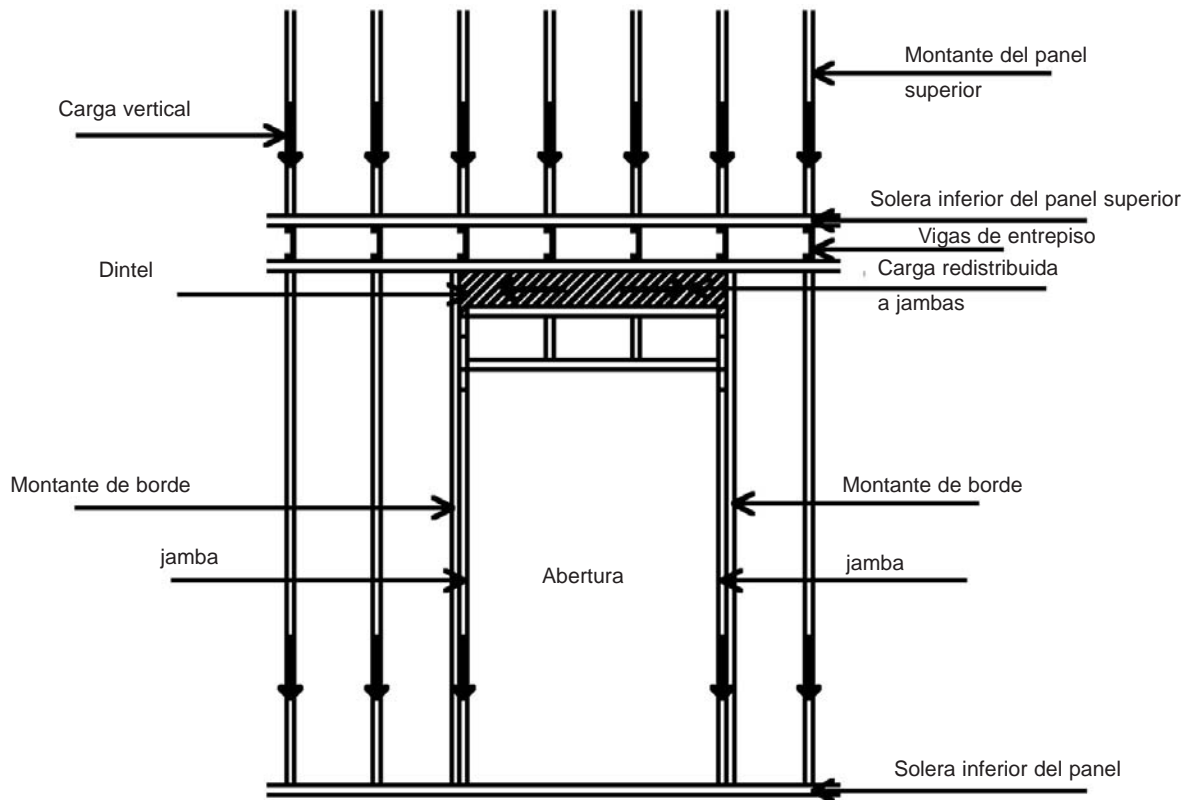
Distribución de los esfuerzos a través de la viga dintel para las jambas.
